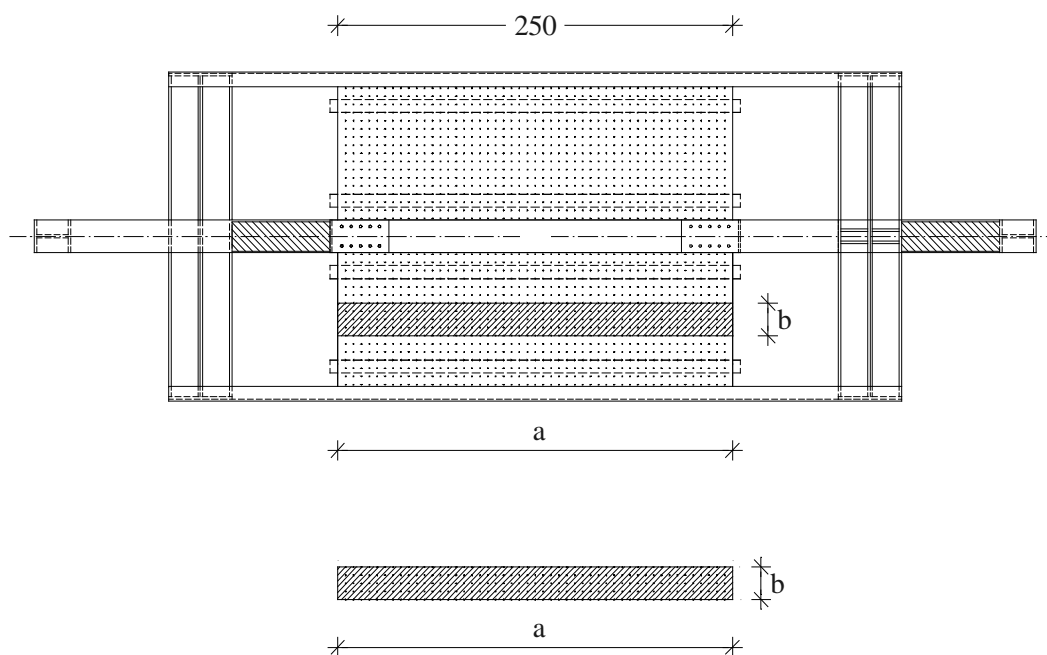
Pianta del banco sperimentale con individuazione dello schema di calcolo utilizzato per verificare la stabilità della lamiera.
